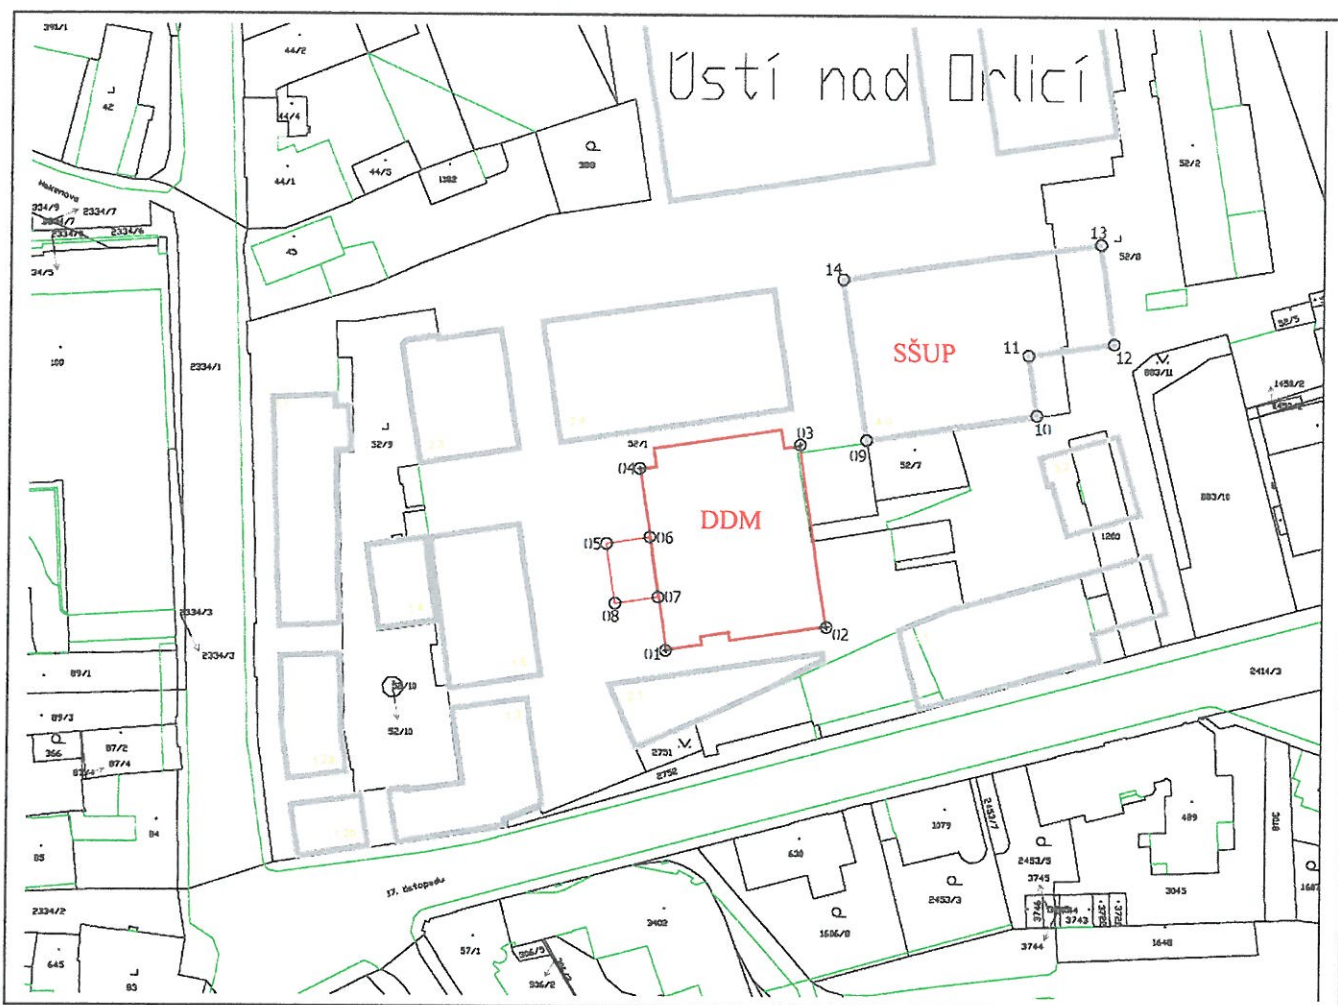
Výřez z celkového situačního výkresu (MS Plan, s.r.o. , 2016) s vyznačením plánovaných staveb DDM a SŠUP. V situace jsou zakresleny původně navrhované vrty geologického IG průzkumu
